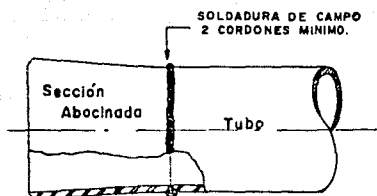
b ENSAMBLE BOCINA Y TUBO
